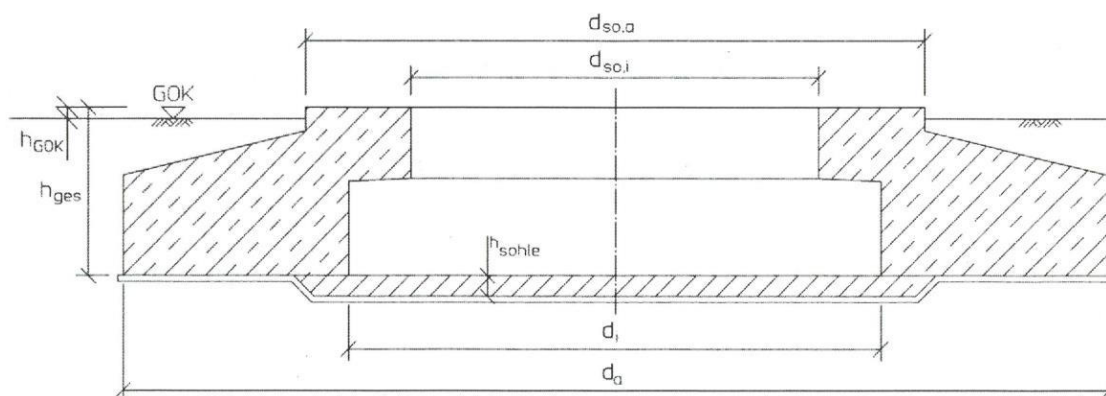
Plans des fondations de l'éolienne de type E-92 mât béton (Source : ENERCON)
